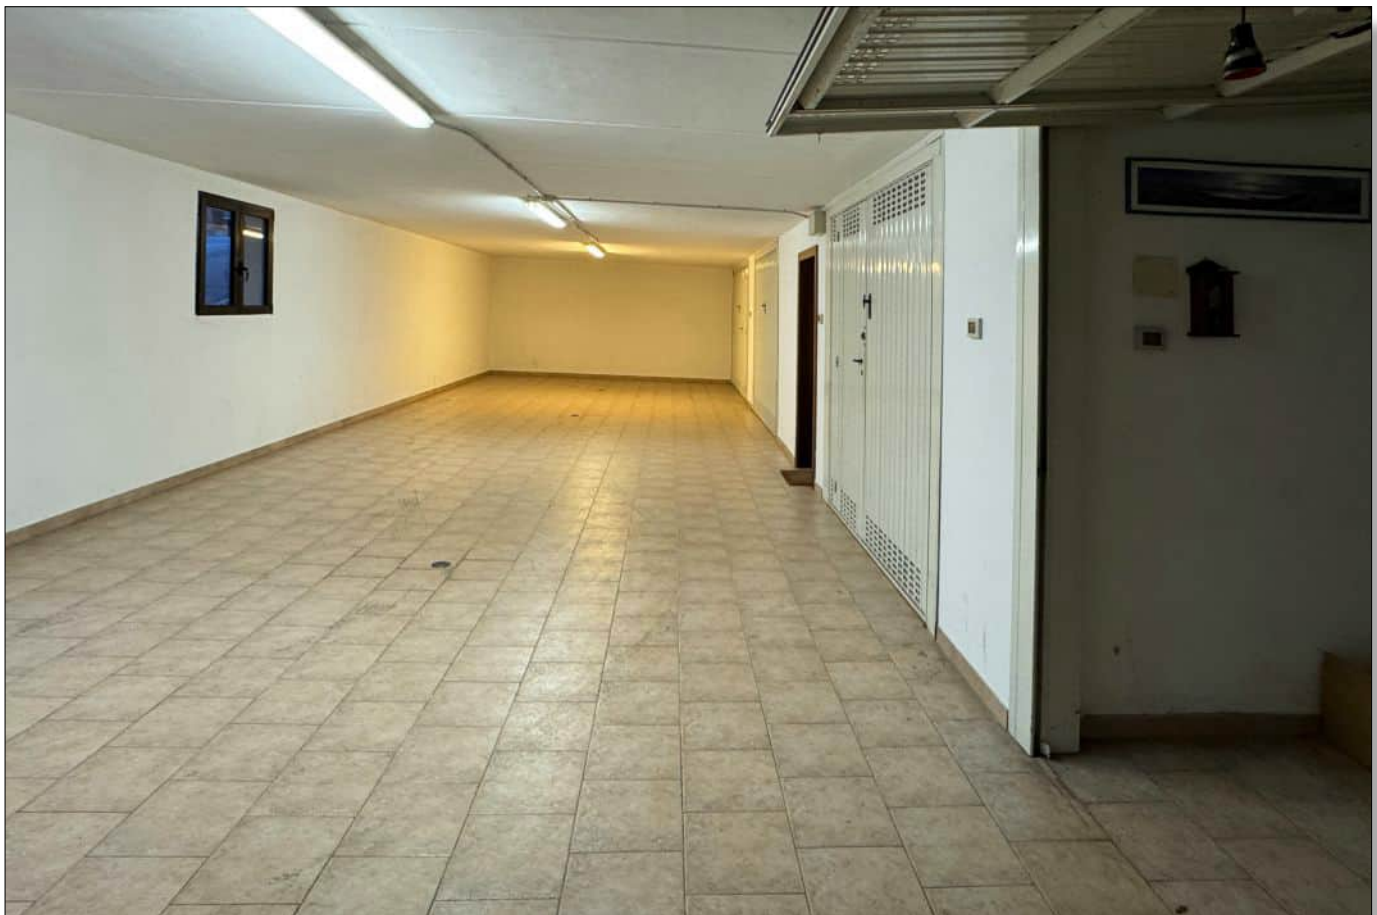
Vista dell'area di manovra piano garage - sulla destra il garage pignorato
